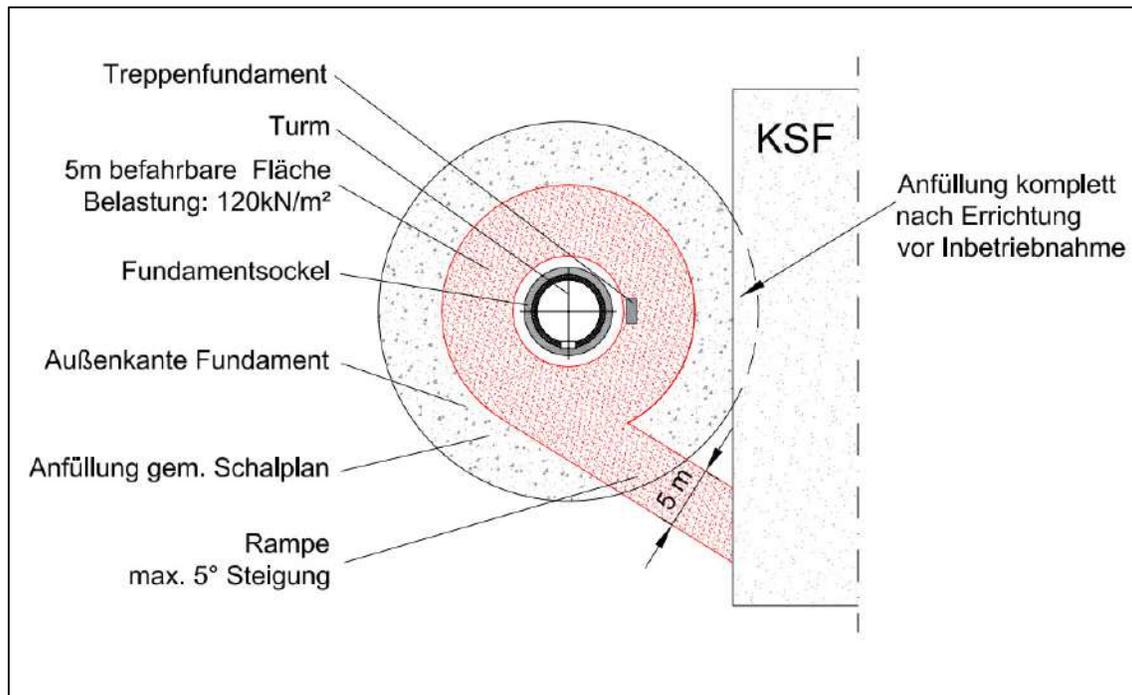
Rampe zwischen KSF und Fundament bei Stahltürmen mit Außenflansch
